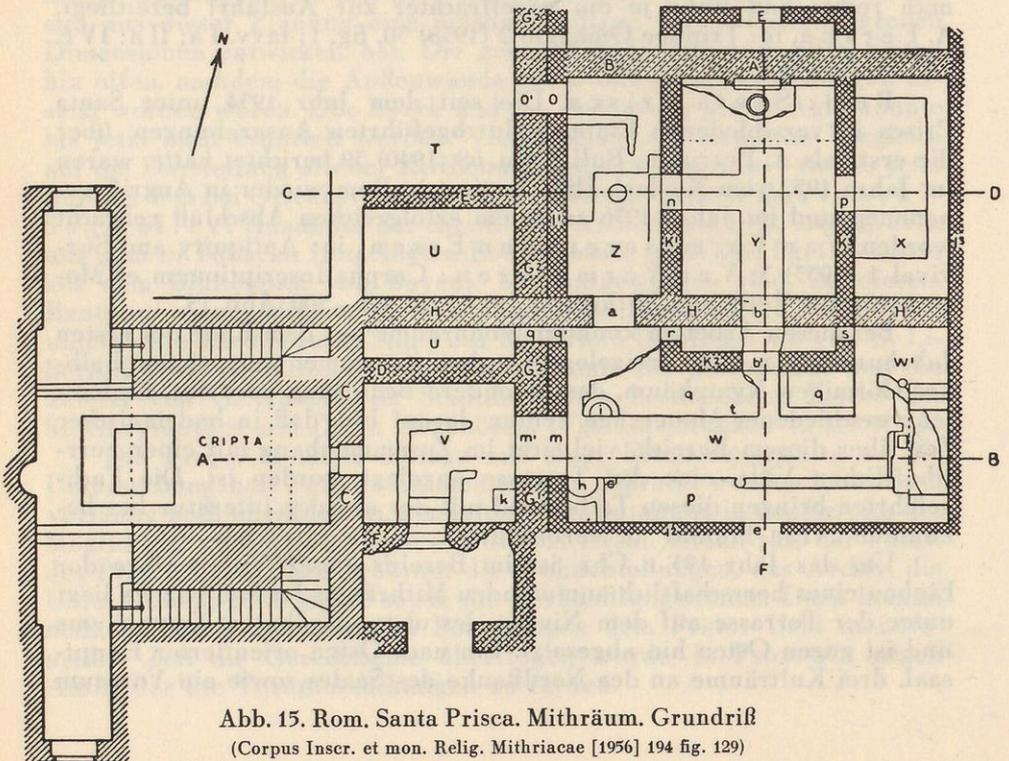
Rom. Santa Prisca. Mithräum. Grundriß
